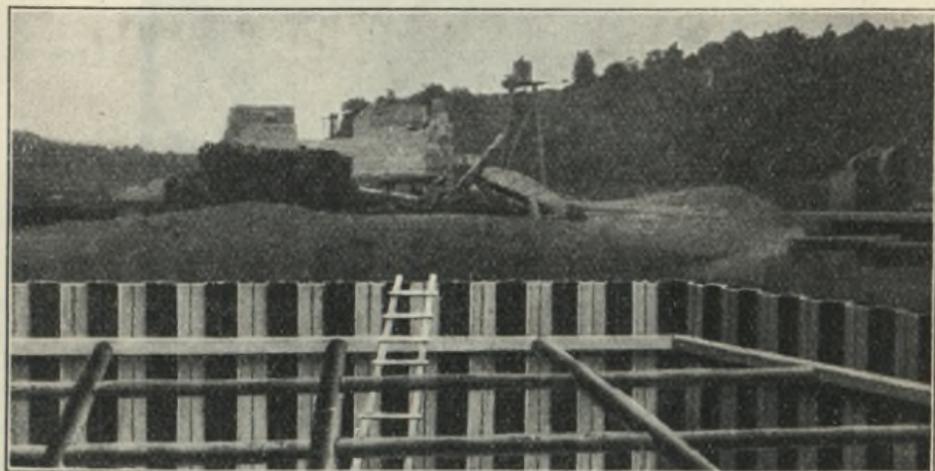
Eisenspundwand Lamp für einen Brückenpfeiler an der Werra.
